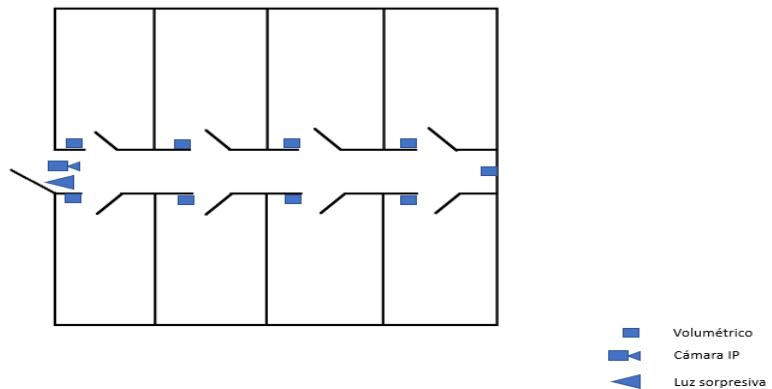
Ilustración IX. Croquis de la planta de una armería. Fuente: (elaboración propia).
